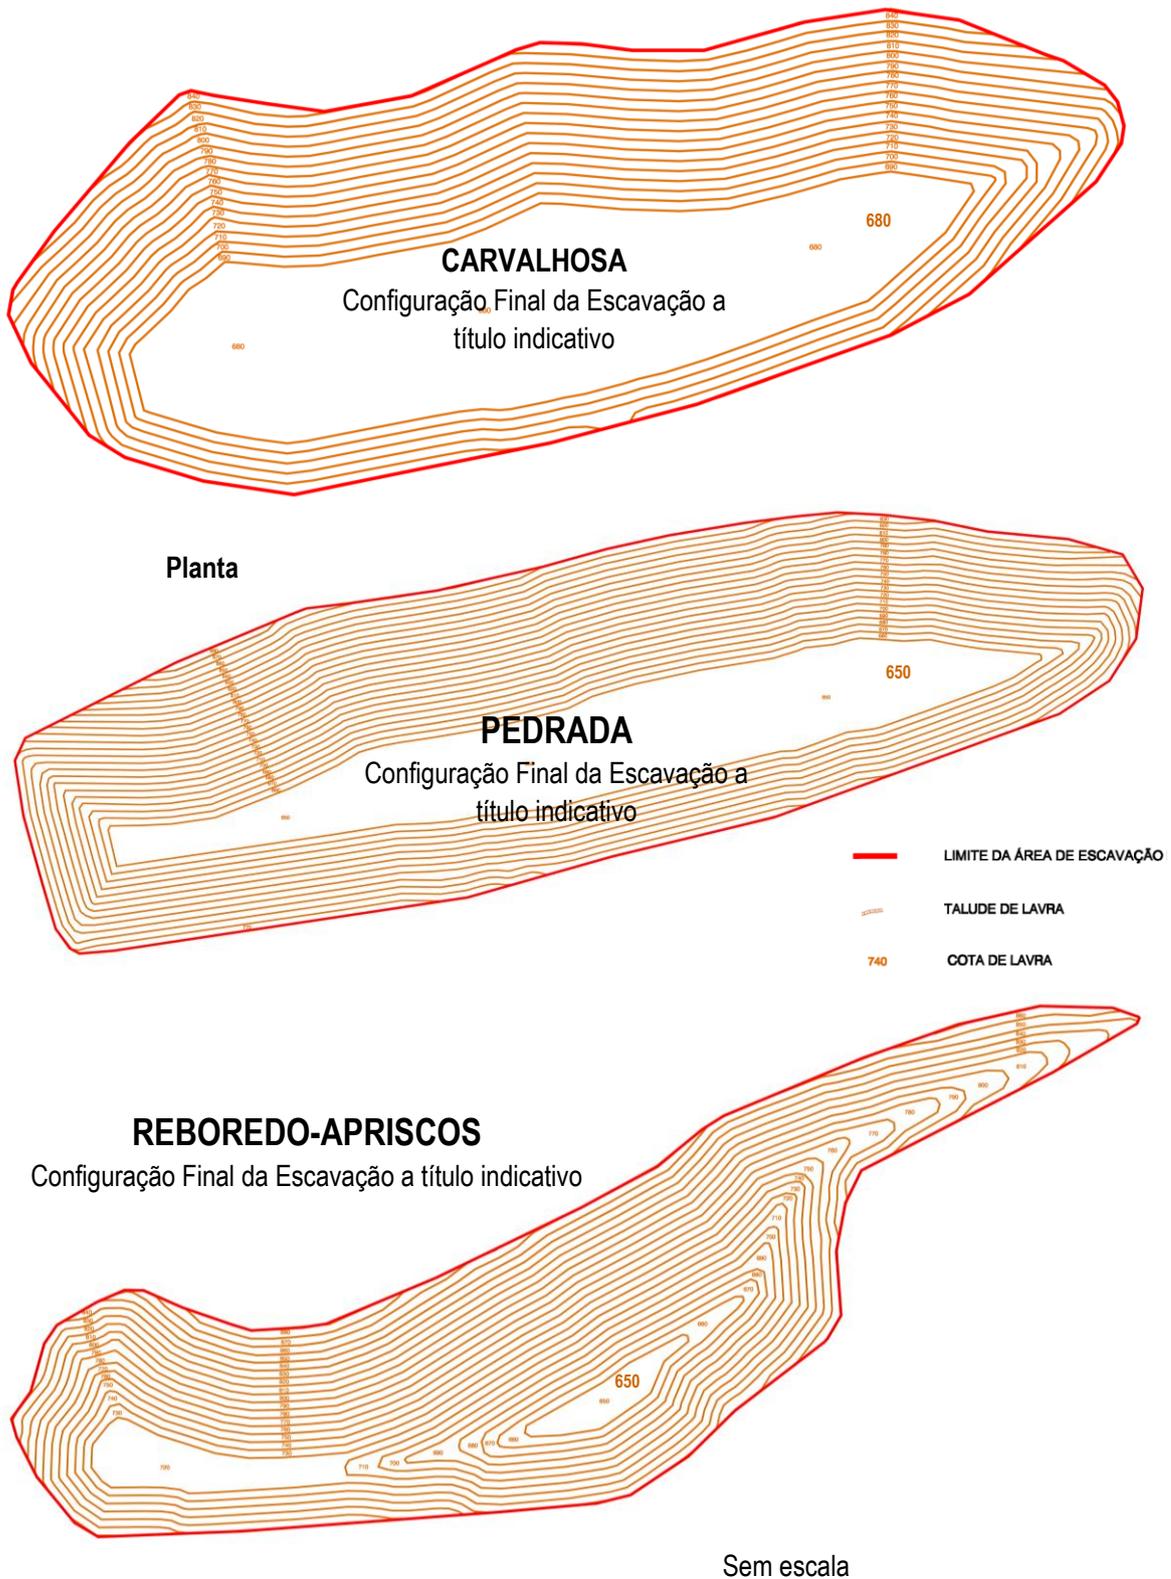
Configuração final de escavação na Carvalho, Pedrada e Reboredo-Apriscos, em planta, a título indicativo.
